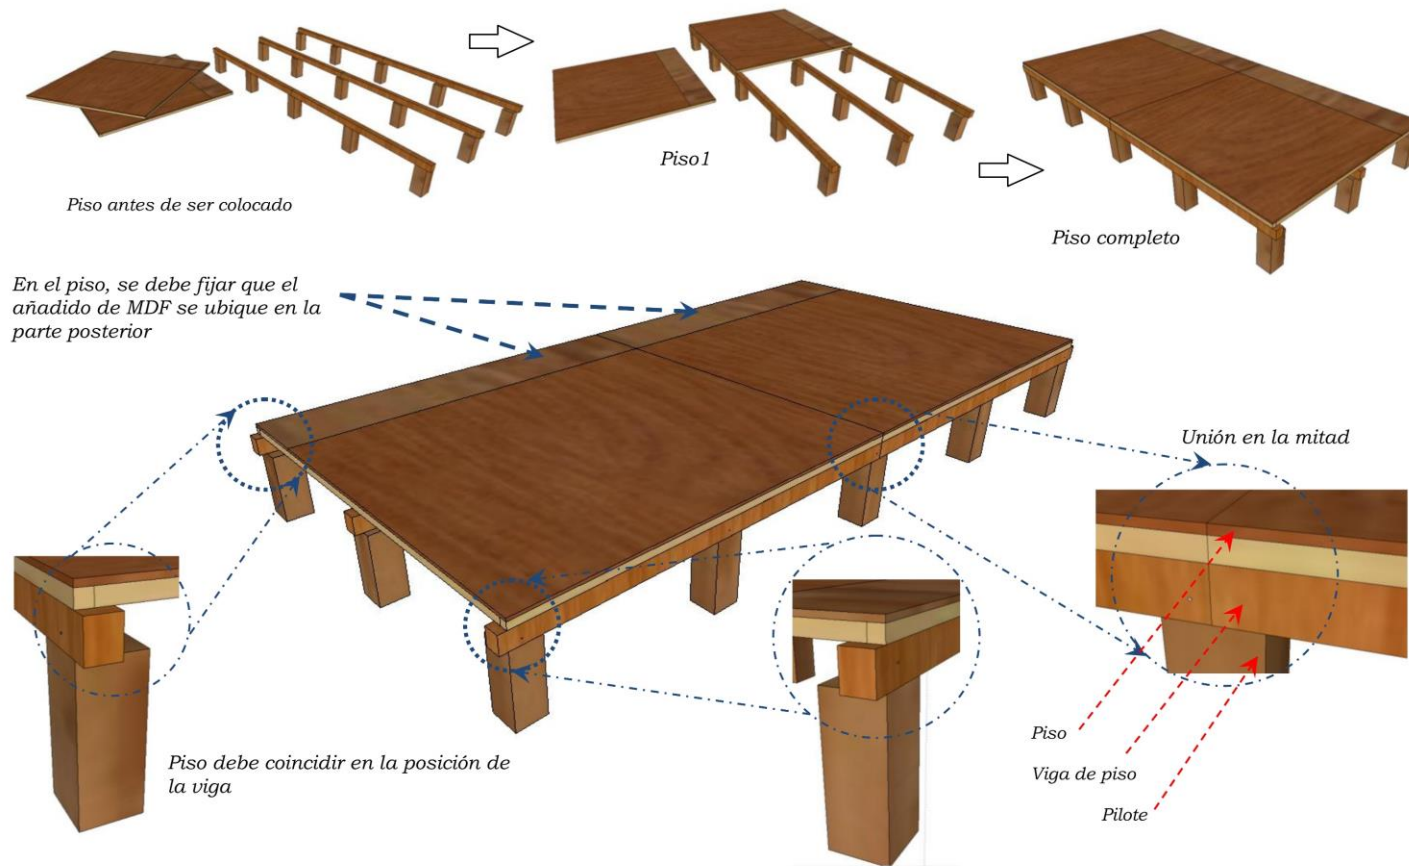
Colocación de piso, Fuente: Manual para la construcción - TECHO
